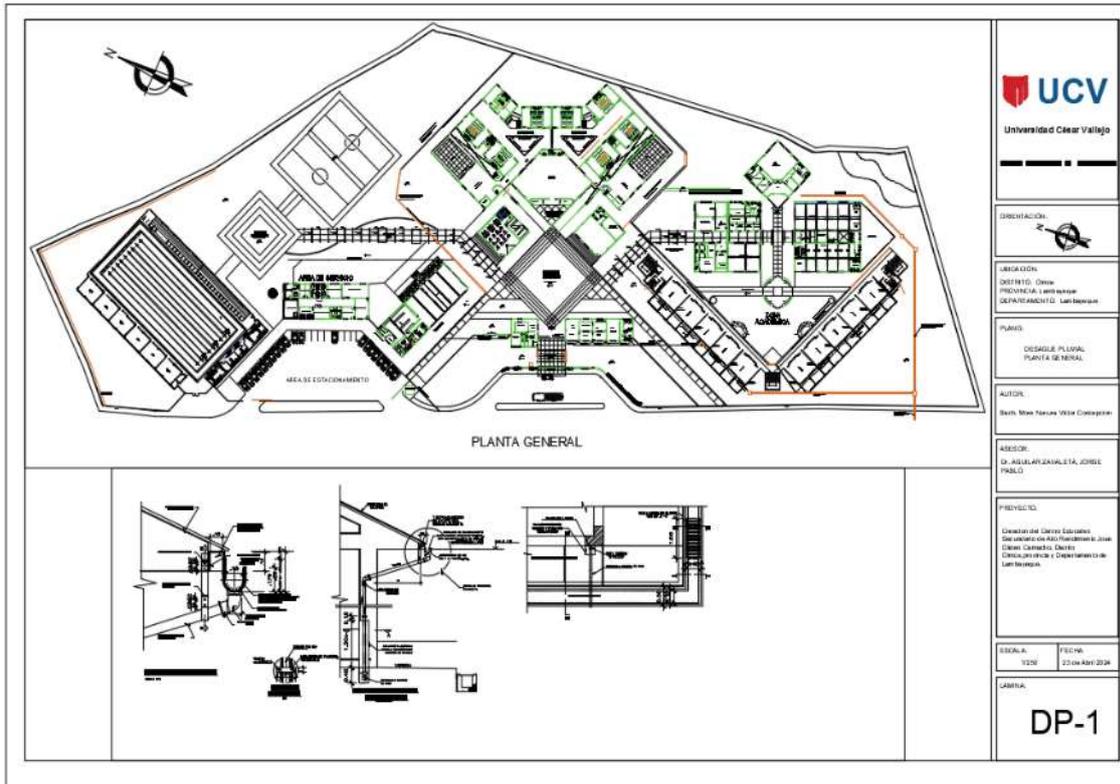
Plano De Desagüe Pluvial - Primer Nivel
